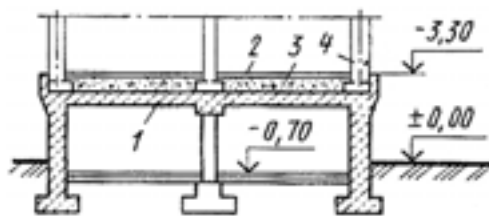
Поперечный разрез убежища, расположенного в первом этаже промышленного здания: 1 — конструкция покрытия; 2 — конструкция пола второго этажа здания; 3 — грунтовая засыпка; 4 — ограждающие конструкции здания
